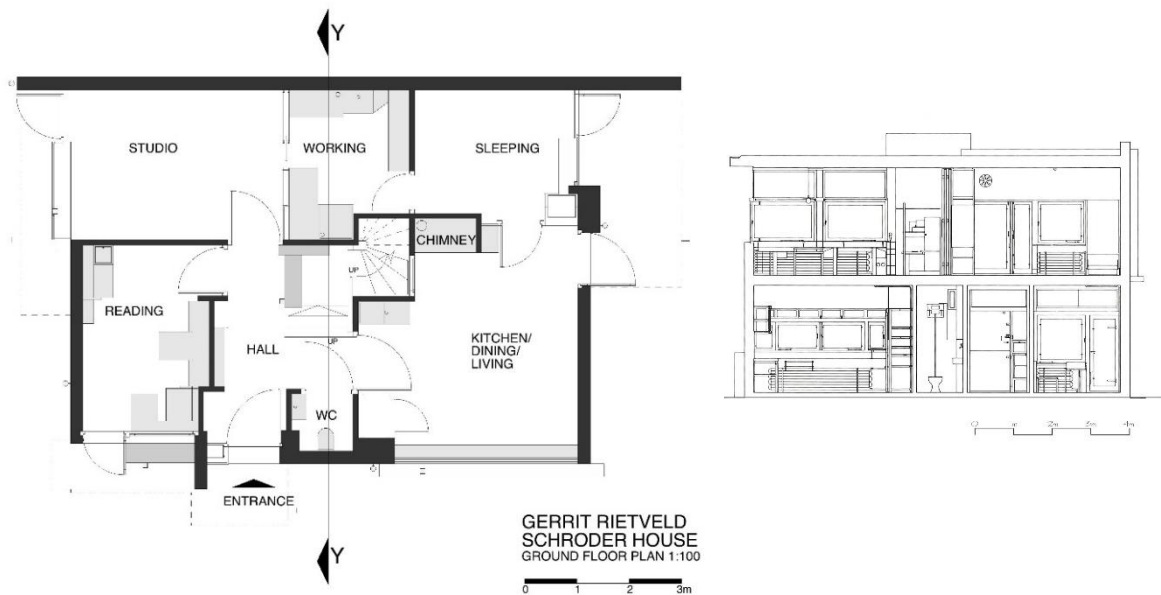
Planta Baixa, Residência Schroder. Fonte: Archdaily
